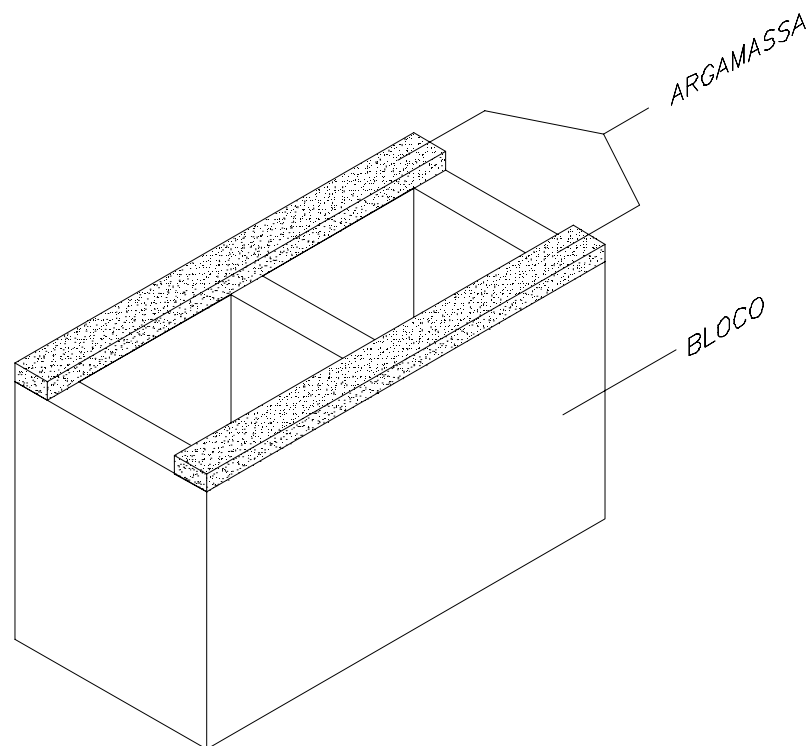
Assentamento de argamassa somente nas faces externas longitudinal (face Shell) do bloco
